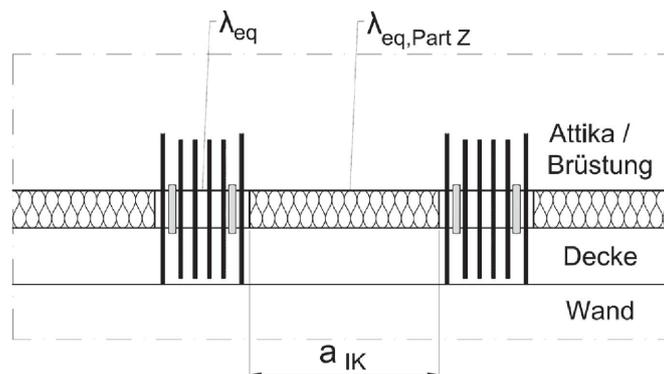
Darstellung zweier Schnittachsen für die Ermittlung von $\lambda_{eq, Mittel}$ eines Attika-/Brüstungsanschlusses mit Schöck Isokorb® CXT Typ A und dazwischen liegendem Schöck Isokorb® CXT Typ A Part Z
